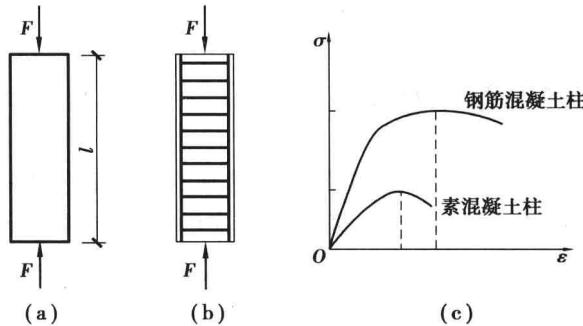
素混凝土与钢筋混凝土轴心受压构件
